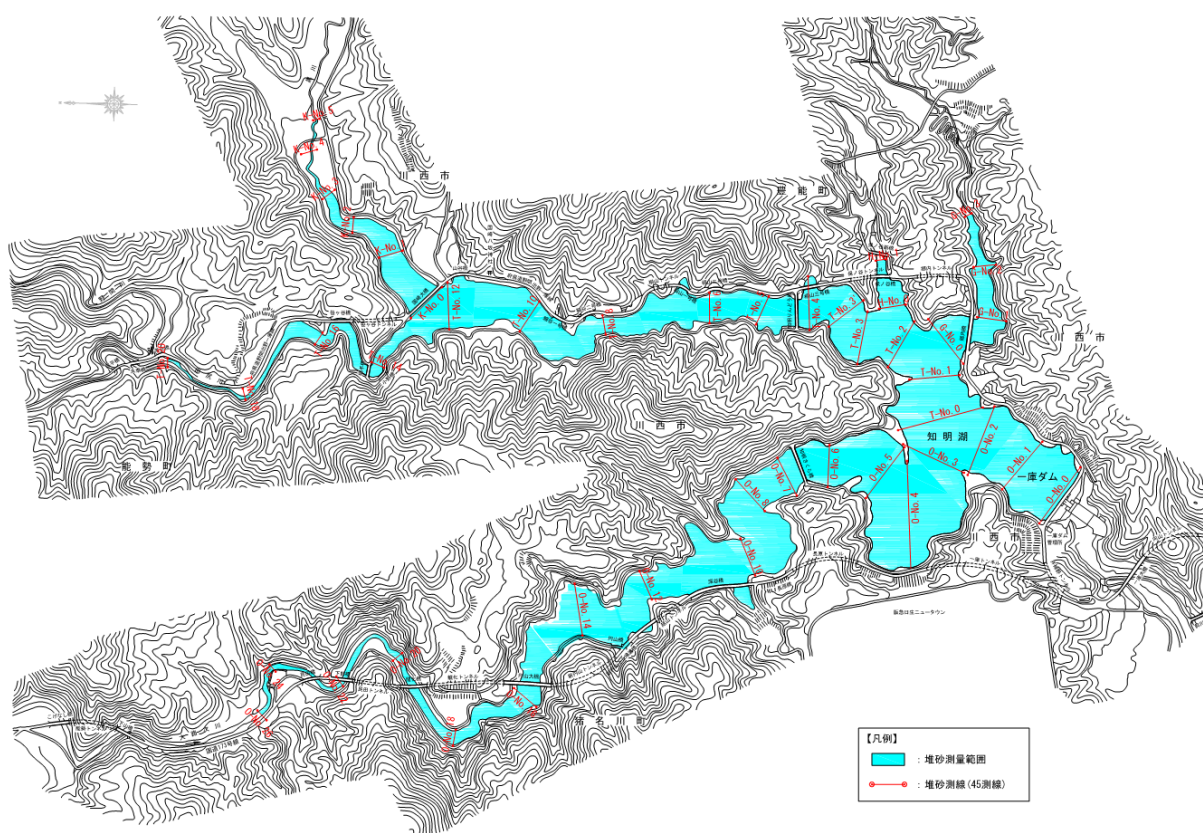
一庫ダム堆砂測量平面図(測線図)
